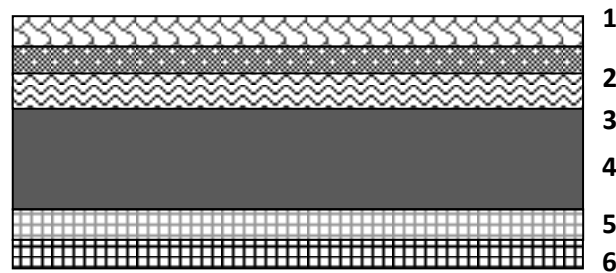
Détail des constituants du plancher terrasse inaccessible.
